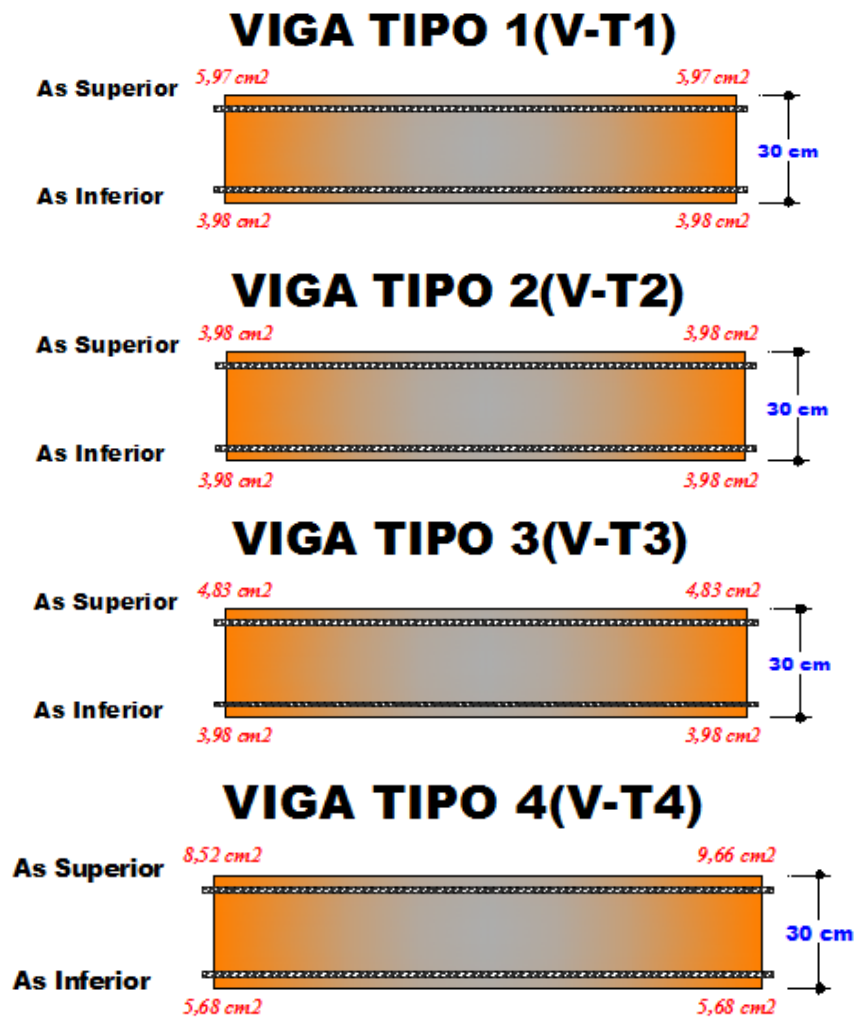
Secciones transversales de vigas y columnas usadas en la vivienda tipo1
